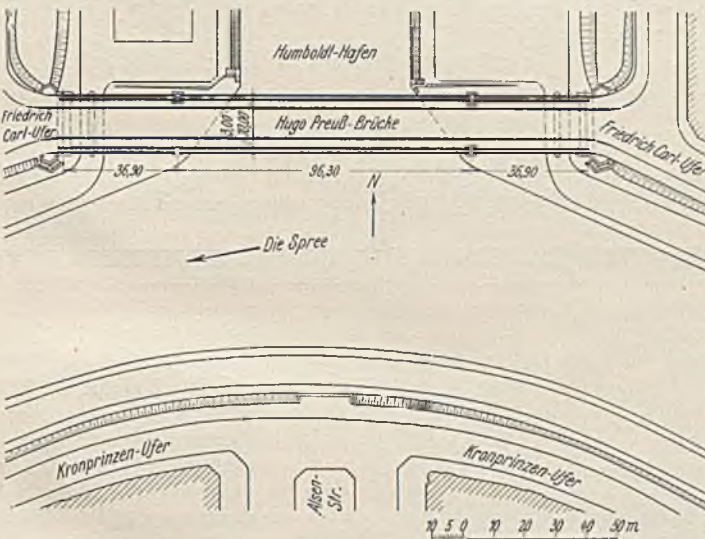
Hugo-Preuß-Brücke. Lageplan.
